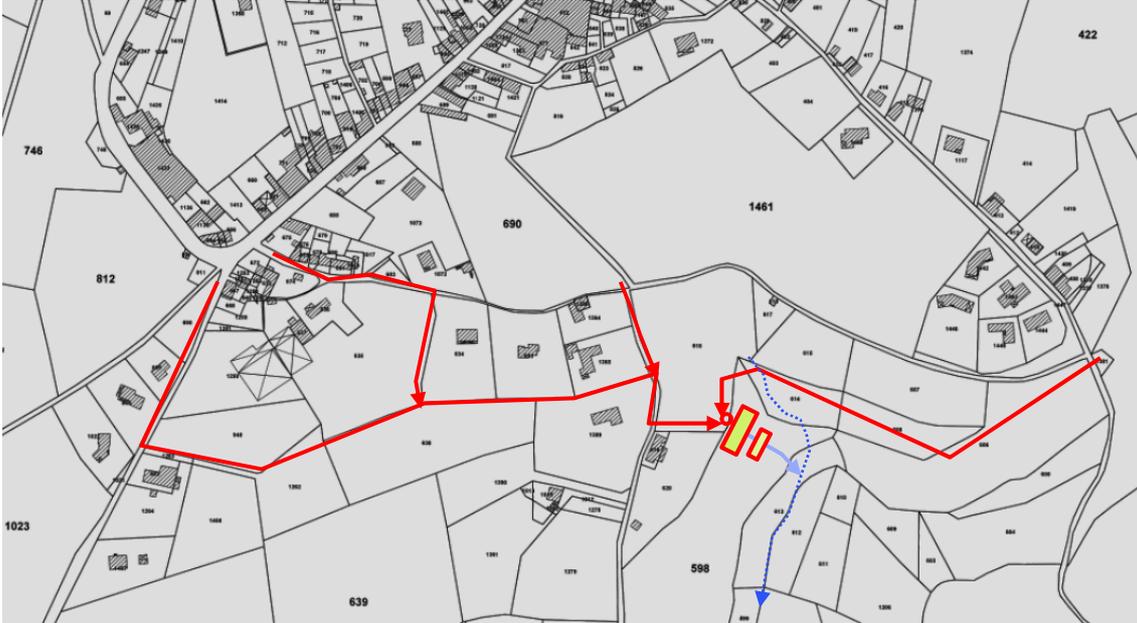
Plan de situation des travaux solution filtre planté de roseaux
